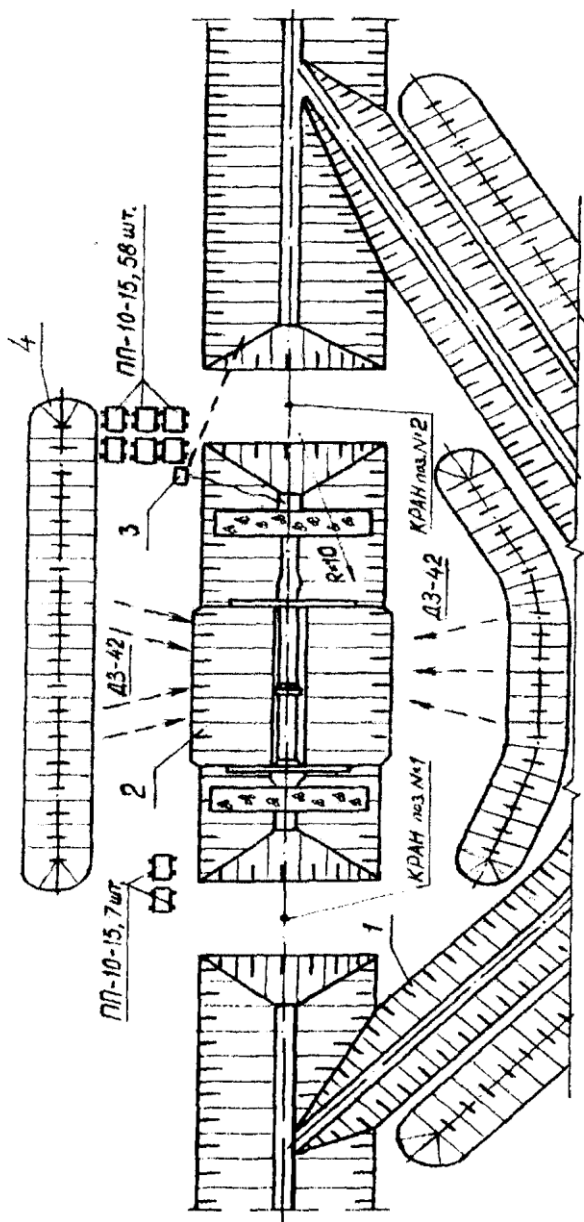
Схема производства работ по монтажу оголовков и тела трубы: 1 – обводной канал, 2 – котлован, 3 – насос, 4 – временный отвал грунта.
